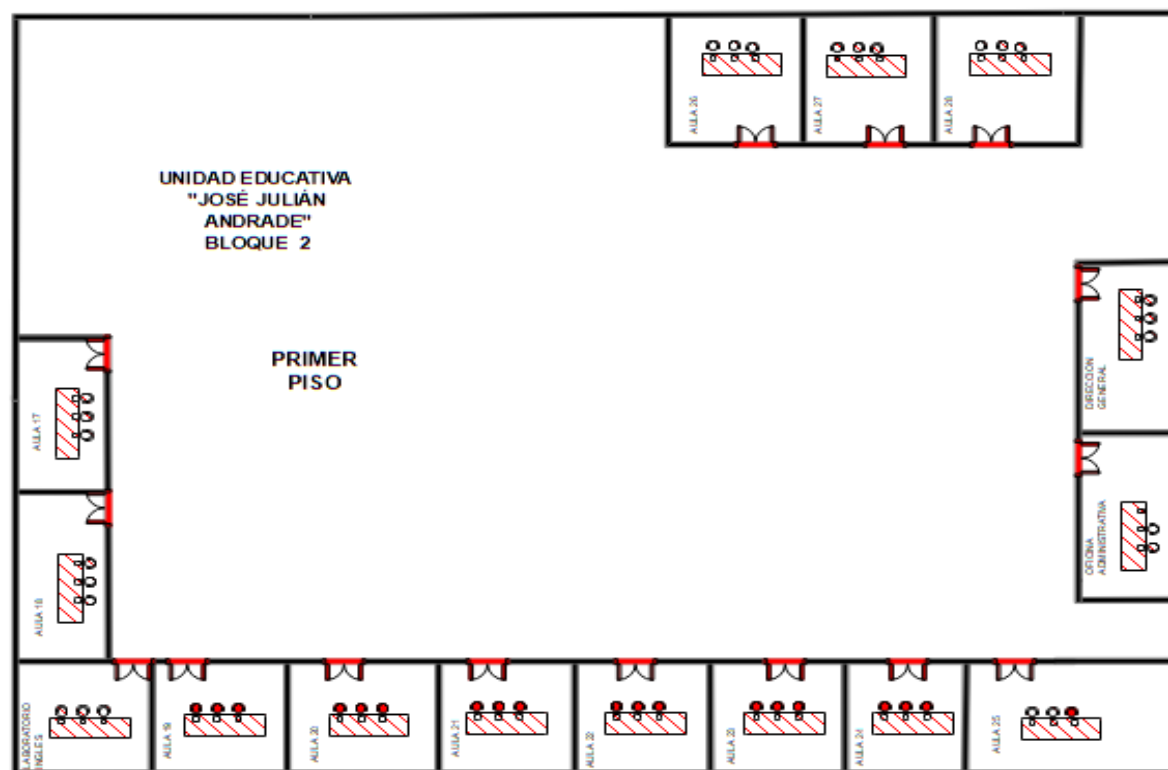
Plano de la estructura del bloque 2, primer piso de la institución
